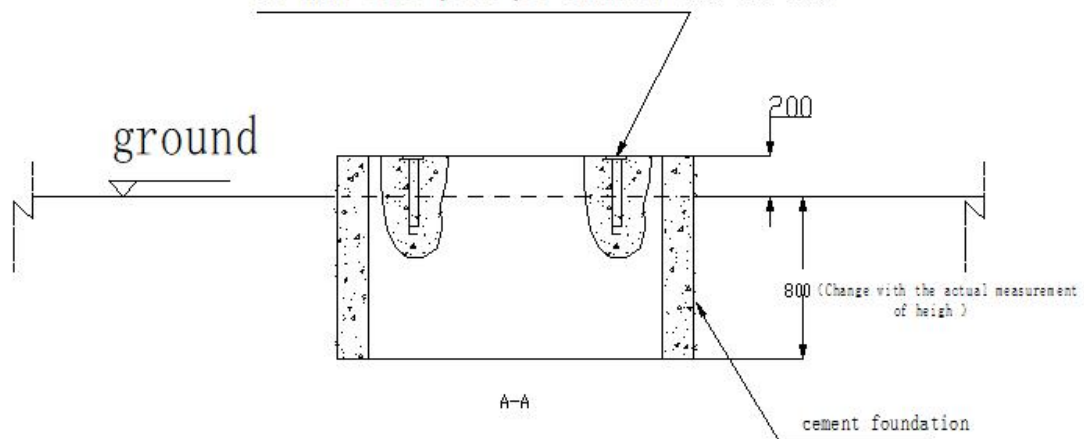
Diagrama esquemático de la construcción de la cimentación.
